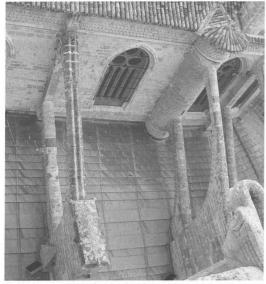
Vista de la cubierta de la girola baja y la nave central desde la torre (foto de los autores 2003)
